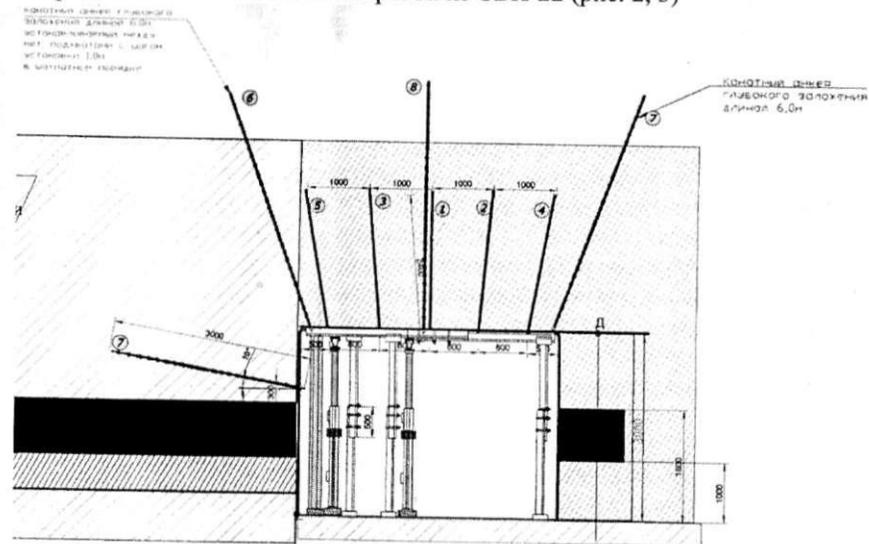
Поперечное сечение демонтажной камеры 161-й лавы пласта С6
